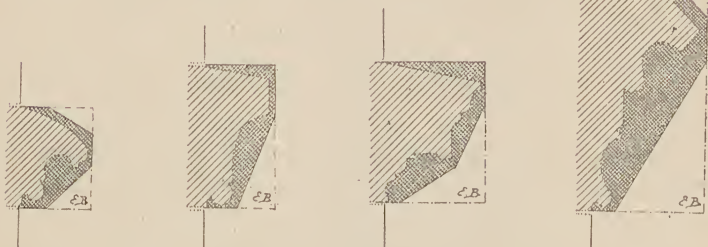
, 96, 97, 98. — Épannelage des pierres.
